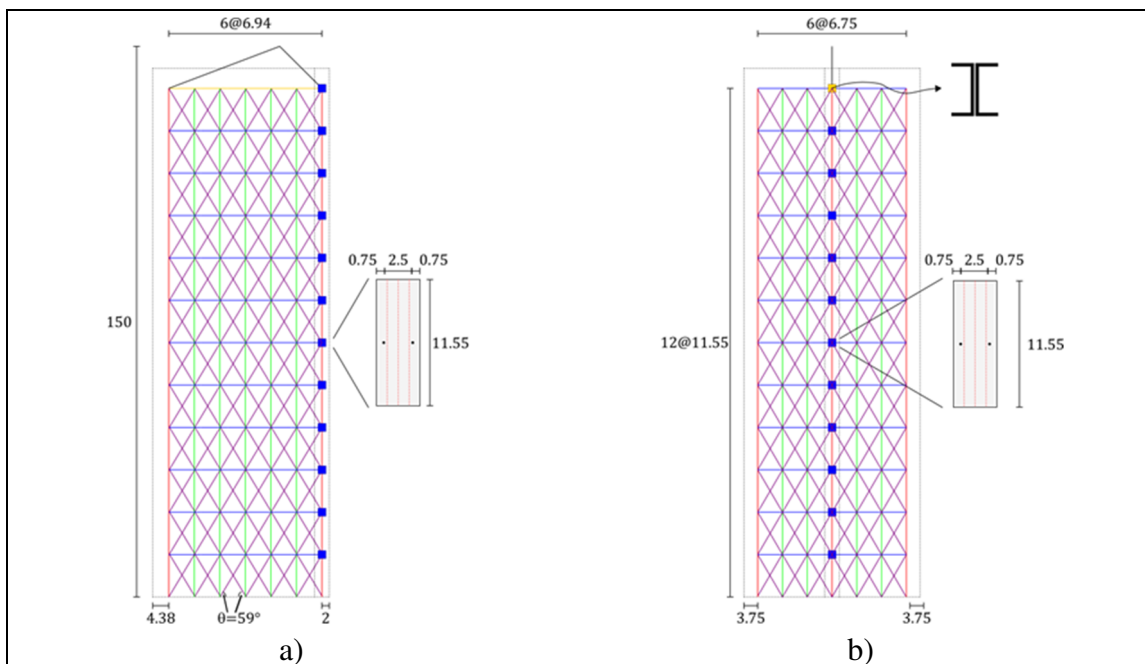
Geometría BTM del muro TW2, dimensiones en pulgadas. a) Alma, b) Ala.
